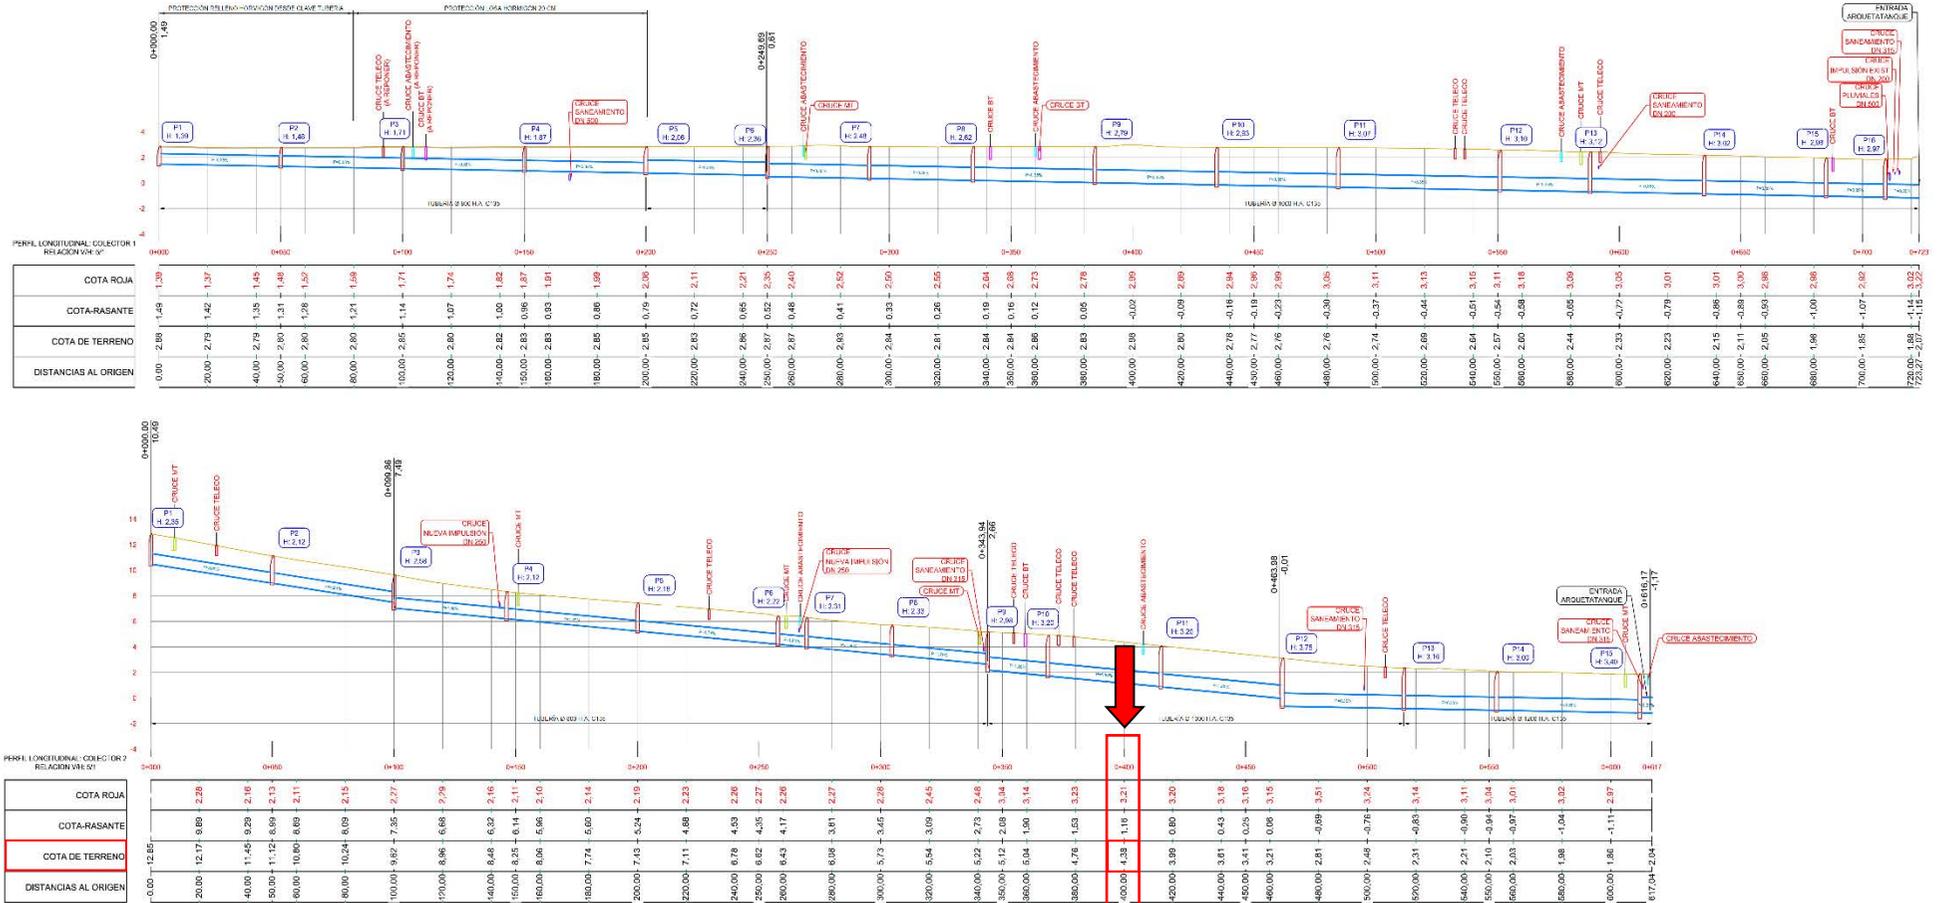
Perfil longitudinal de los colectores en el proyecto de Playa Honda.
